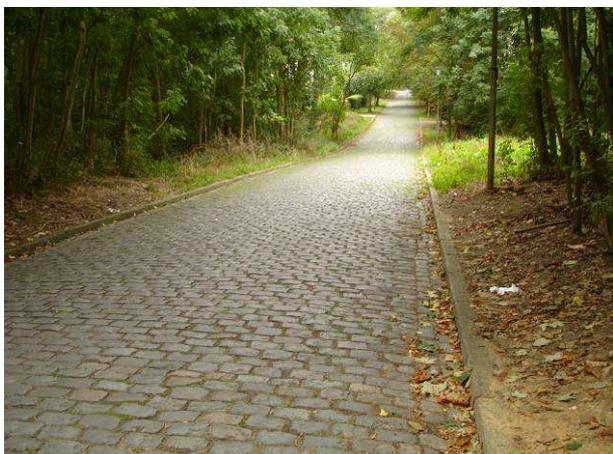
Avenue Buysdelle, depuis l'avenue des Hospices
